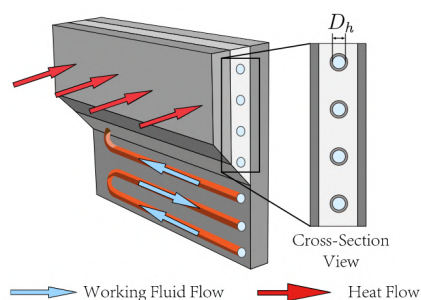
Facciata con isolamento a parete opaca commutabile
